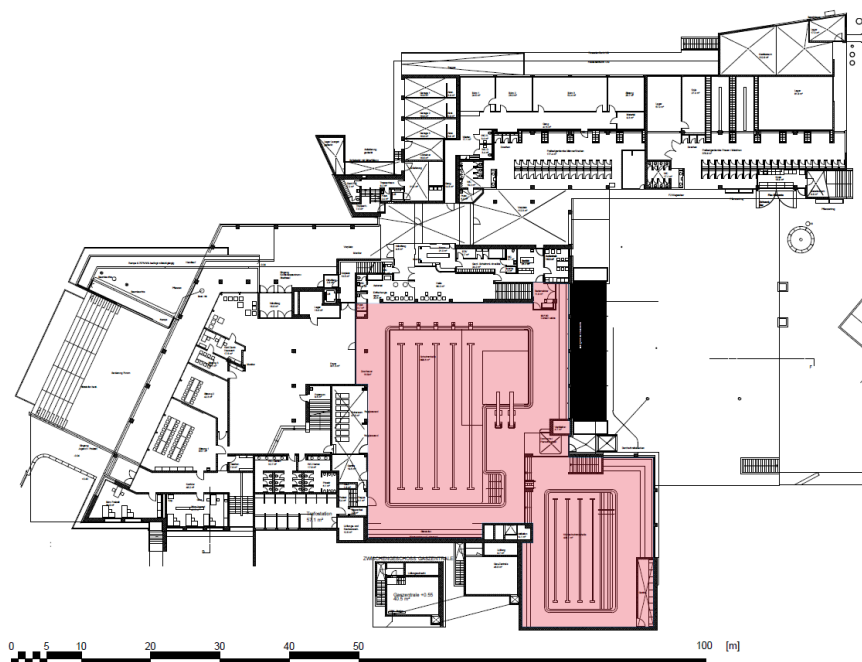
Erdgeschoss und Obergeschoss (Eingriffe Bausubstanz)
